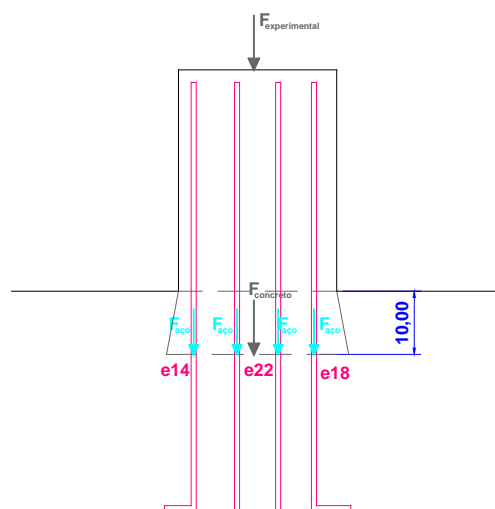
Seção 14-18-22-28 – área de atuação das tensões do concreto
